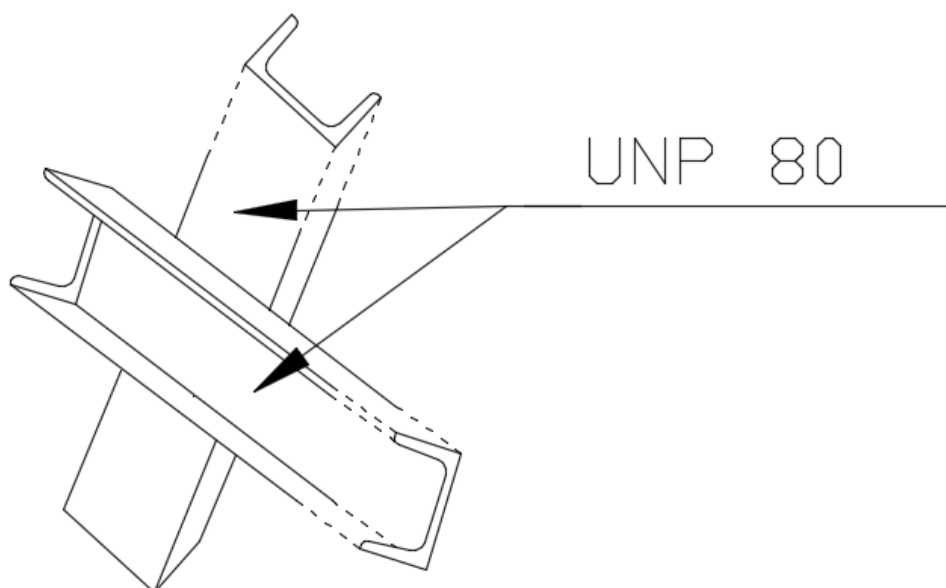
Pormenor do contraventamento em UNP 80 das fachadas laterais
